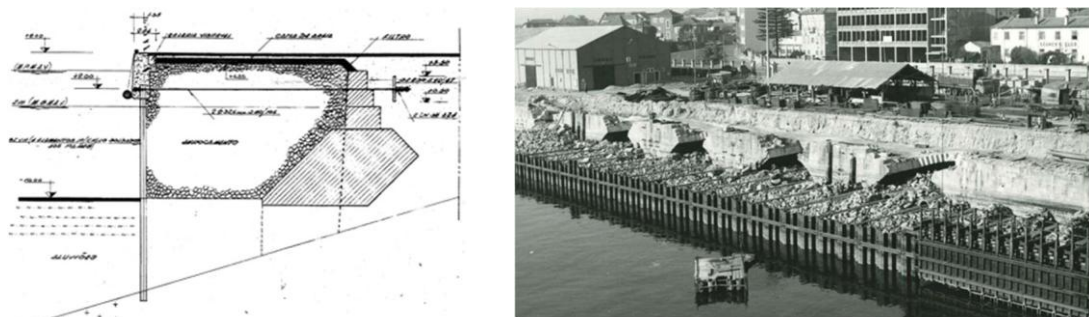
Muro-cais avançado. Perfil transversal (esquerda). Construção do muro-cais avançado (direita).
